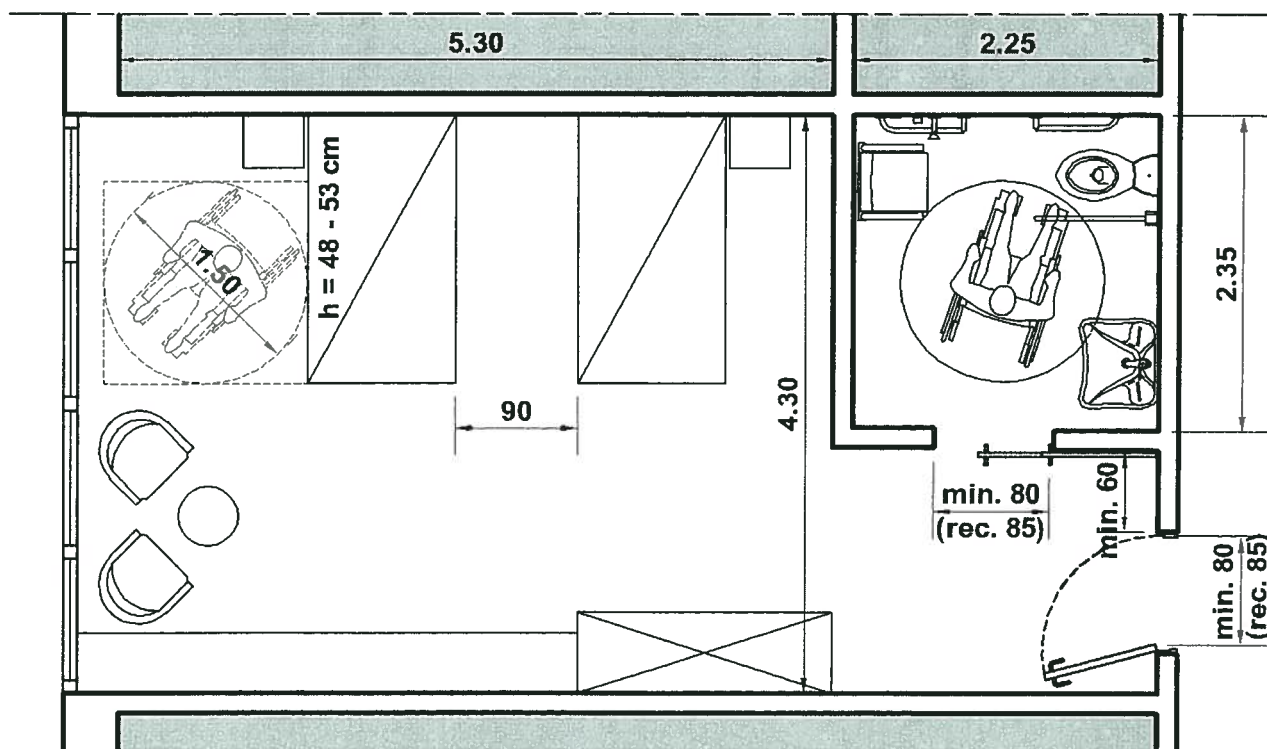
Schemă de amenajare a unei camere de hotel cu două paturi
